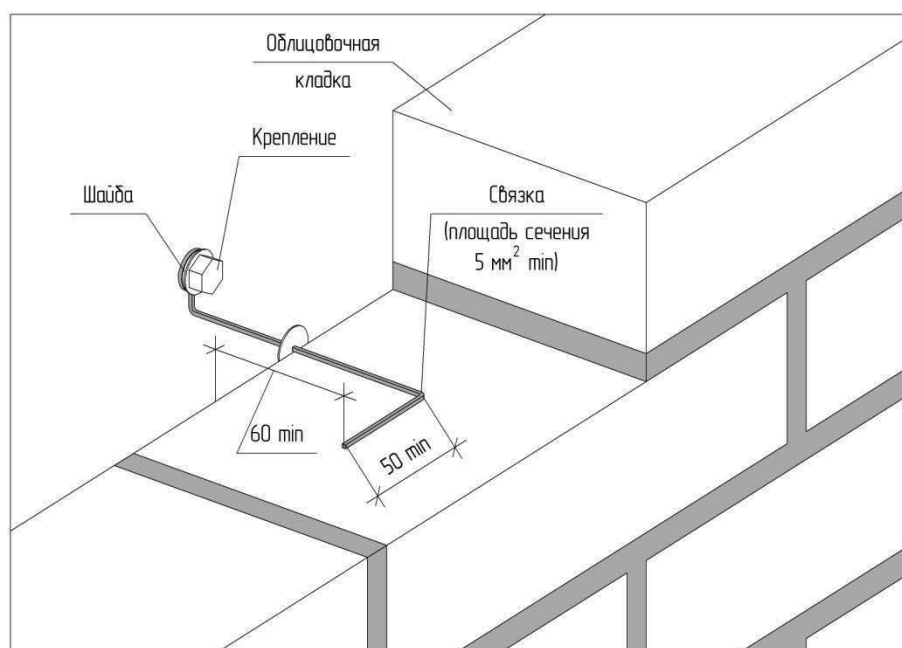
Схема устройства анкерной связки для крепления облицовочной кладки
